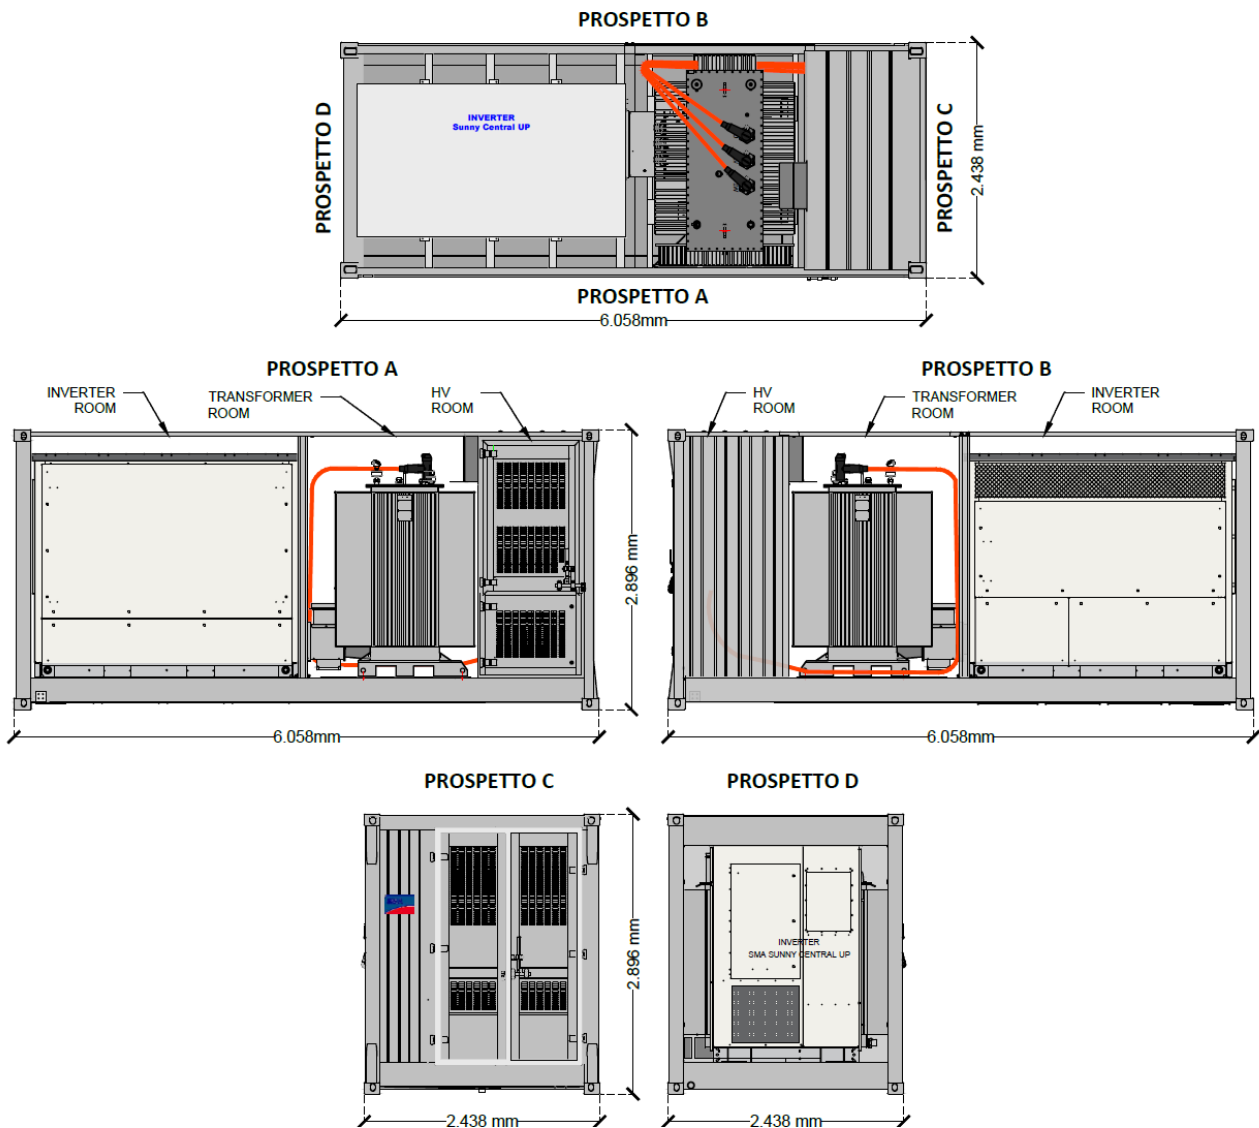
Pianta e Prospetti di dettaglio della Power Station di campo
